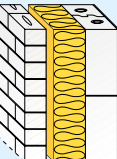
Systemaufbau zweischaliges Mauerwerk mit Wärmedämmung
